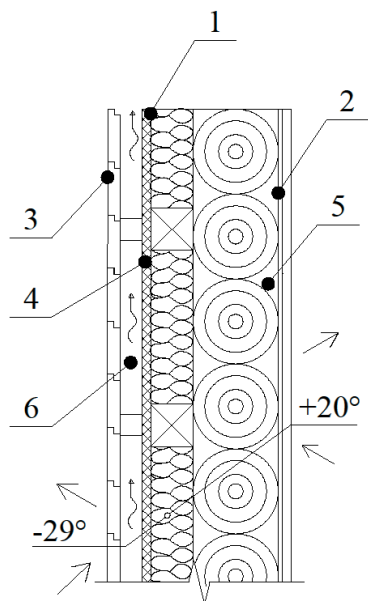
Конструкция стены из оцилиндрованного бревна с наружным утеплением 1 – минераловатная изоляция ISOVER; 2 – пароизоляция ISOVER; 3 – обшивка; 4 – ветрозащитный материал ISOVER SKL; 5 – теплоизоляция швов ISOVER TK; 6 – воздушный зазор
